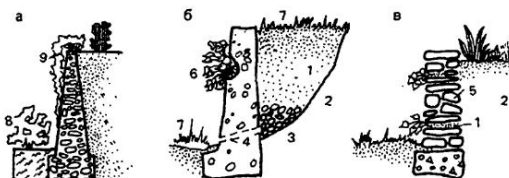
Озеленение подпорных стенок: а – бутовой кладки; б – из бетона; в – из камня или кирпича сухой кладки: 1 – насыпной грунт; 2 – прорытый грунт; 3 – щебень; 4 – дренаж
